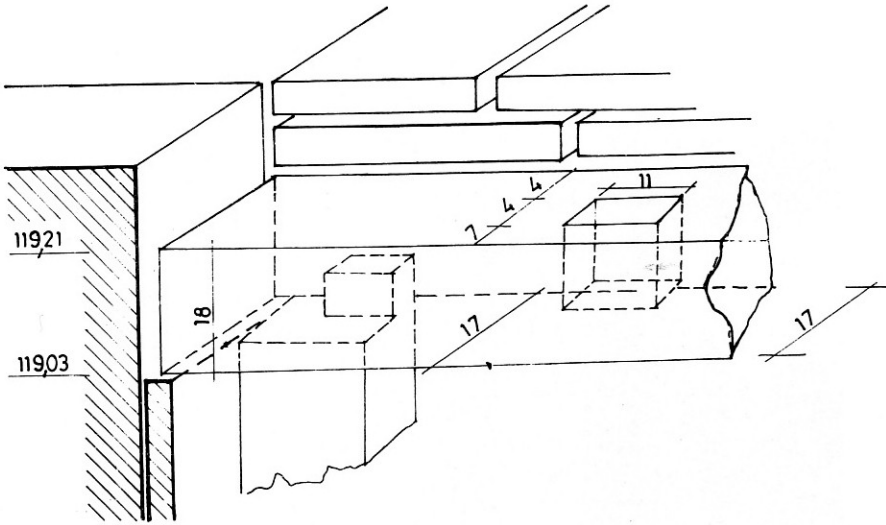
Coupes 4.4 et 4b, 4b sur la structure 15.
